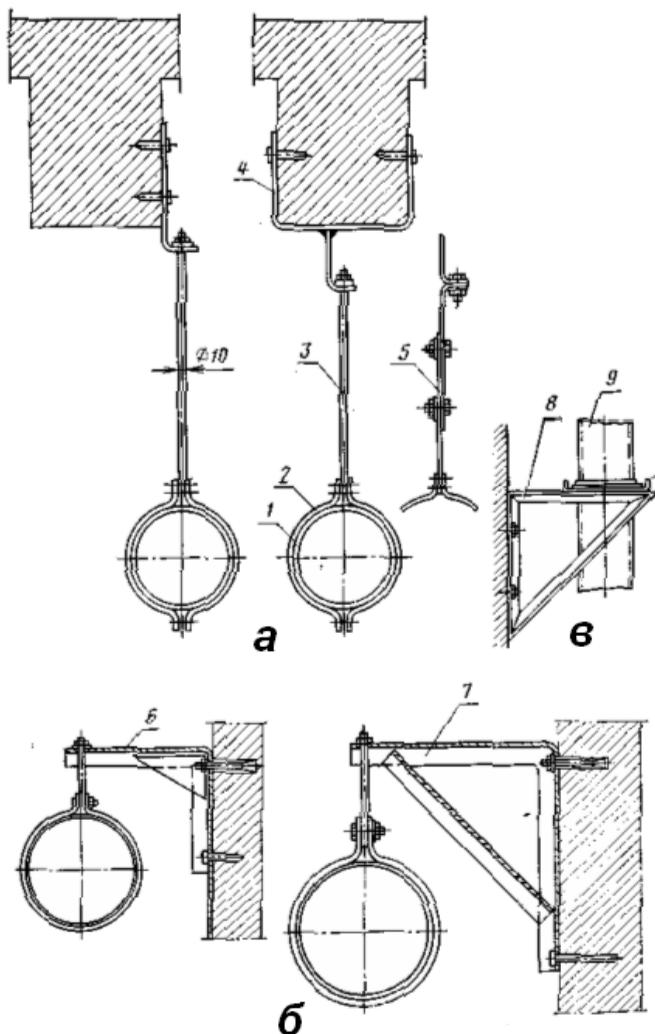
Крепление трубопроводов для воздуха: а, б – горизонтального воздухопровода к строительным балкам на подвесках и кронштейнах; в – вертикального воздухопровода к стене на кронштейне; 1 – горизонтальный участок воздухопровода; 2 – хомут подвески; 3 – тяга подвески из прутка; 4 – кронштейн подвески (крепят дюбелями); 5 – телескопическая тяга подвески; 6 – кронштейн для труб диаметром до 315 мм (крепят коническими болтами и дюбелями); 7 – кронштейн для труб диаметром более 400 мм (крепят коническими болтами и дюбелями); 8 – кронштейн для подвески вертикального воздухопровода; 9 –
